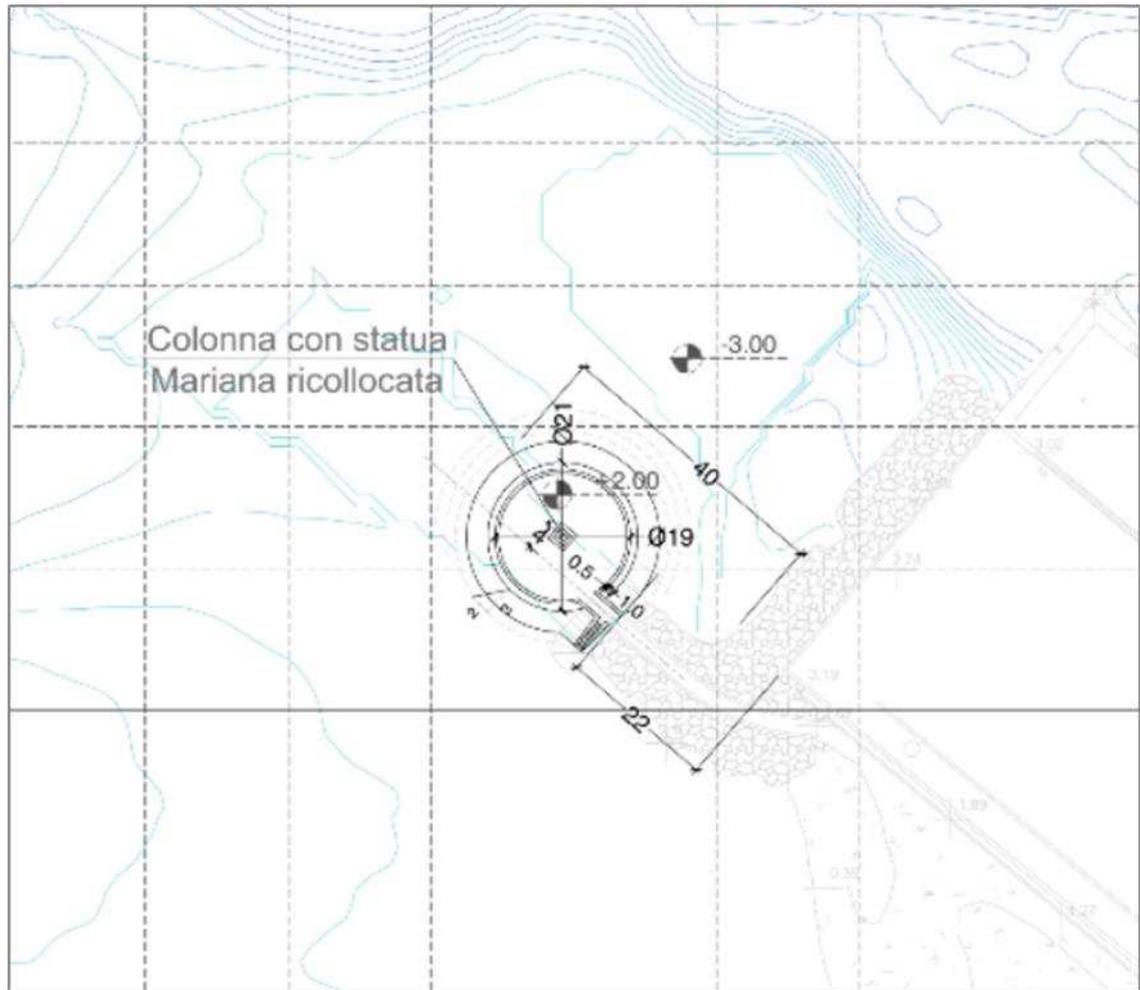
Dettaglio della planimetria per la soluzione progettuale della nuova testata
